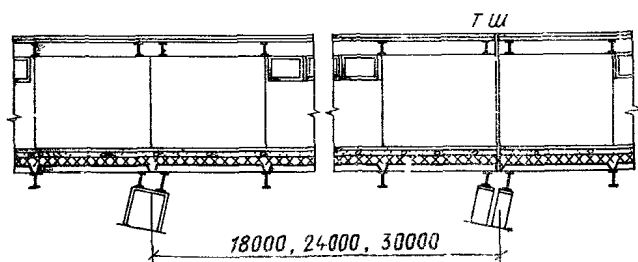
Продольный разрез отопляемой галереи с облегченными конструкциями
